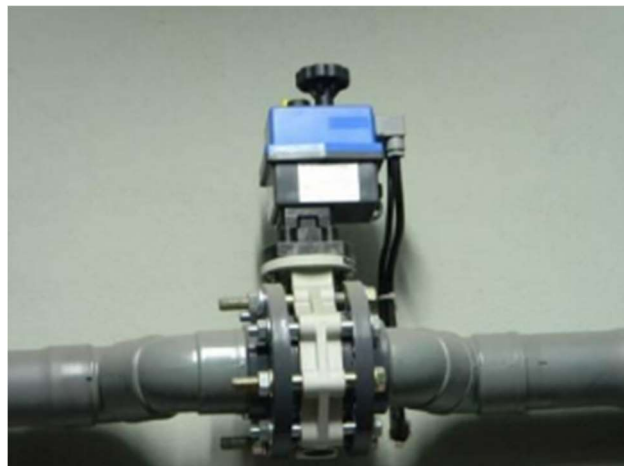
Příklad hospodaření s dešťovou vodou v hotelu Rafayel, Londýn [37]
